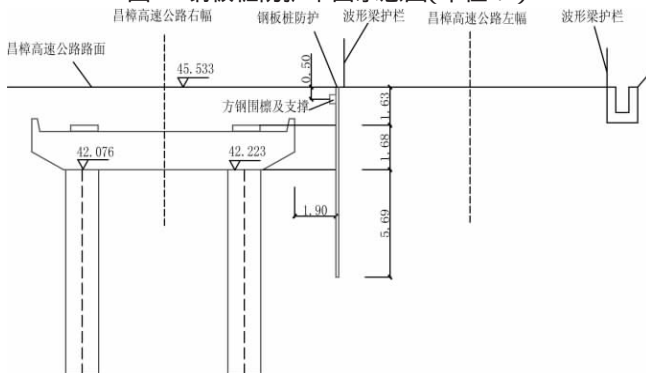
施工右幅期间对左幅高速公路路基采用钢板桩防护立面示意图(单位 m)
